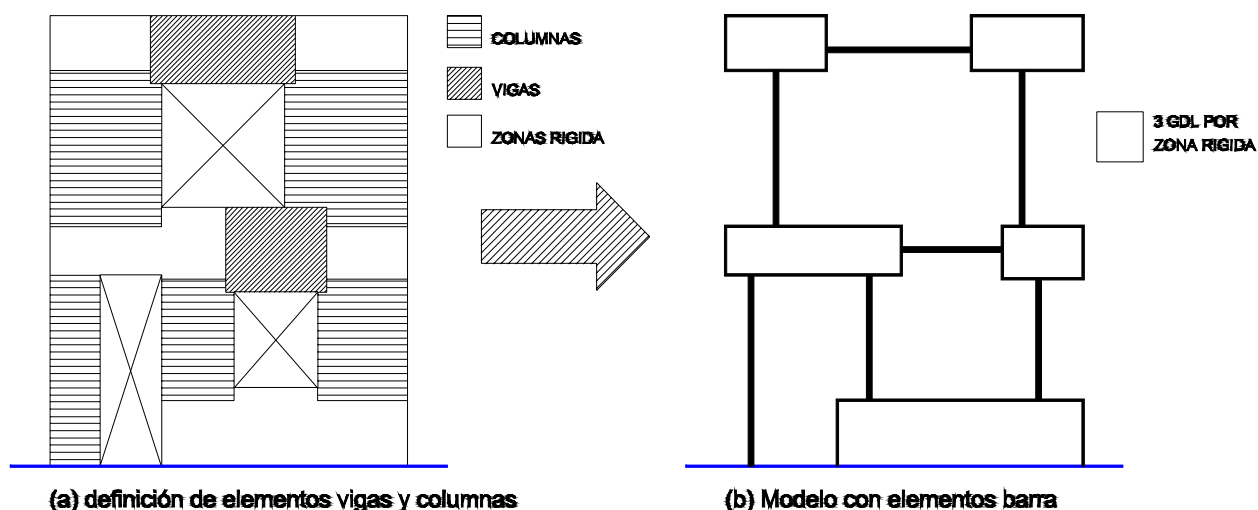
Definición de elementos modelo muro Columna Ancha (Wilson, 1998)
